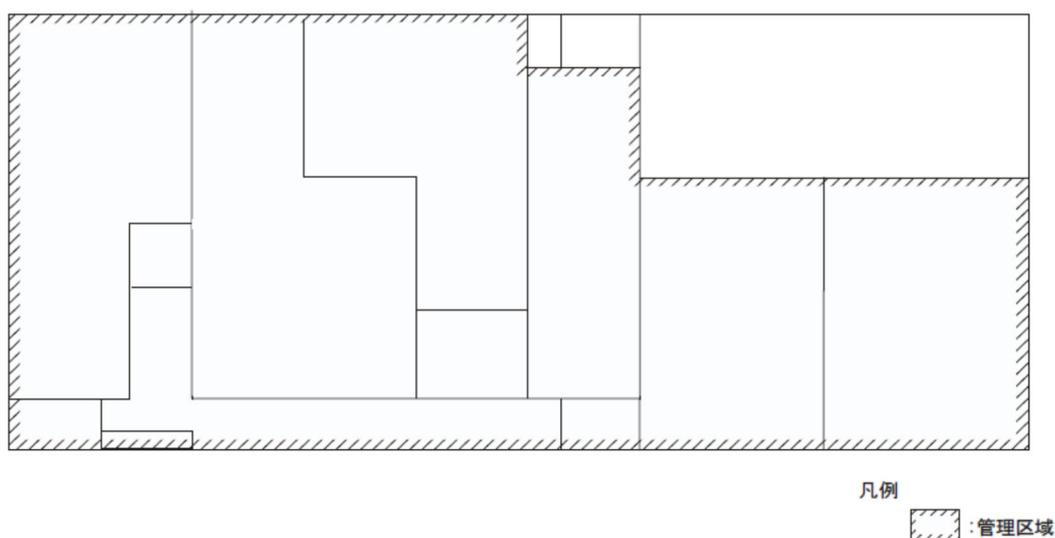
プルトニウム廃棄物処理開発施設地下1階平面図
